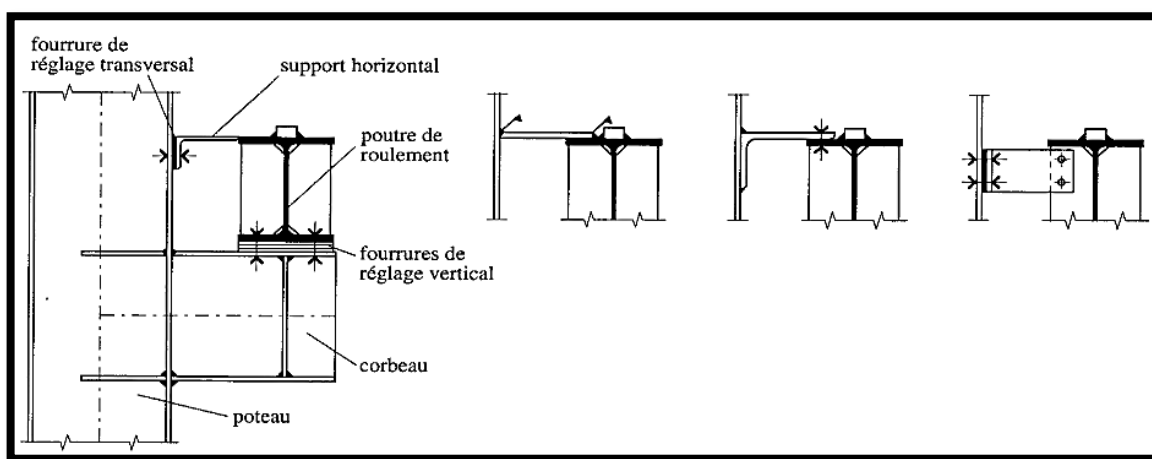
13 Exemples de supports horizontaux de la poutre de roulement
